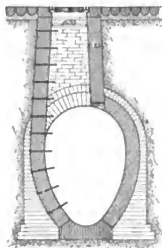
Kanal mit Seiteneingang. M. 1 : 125.
